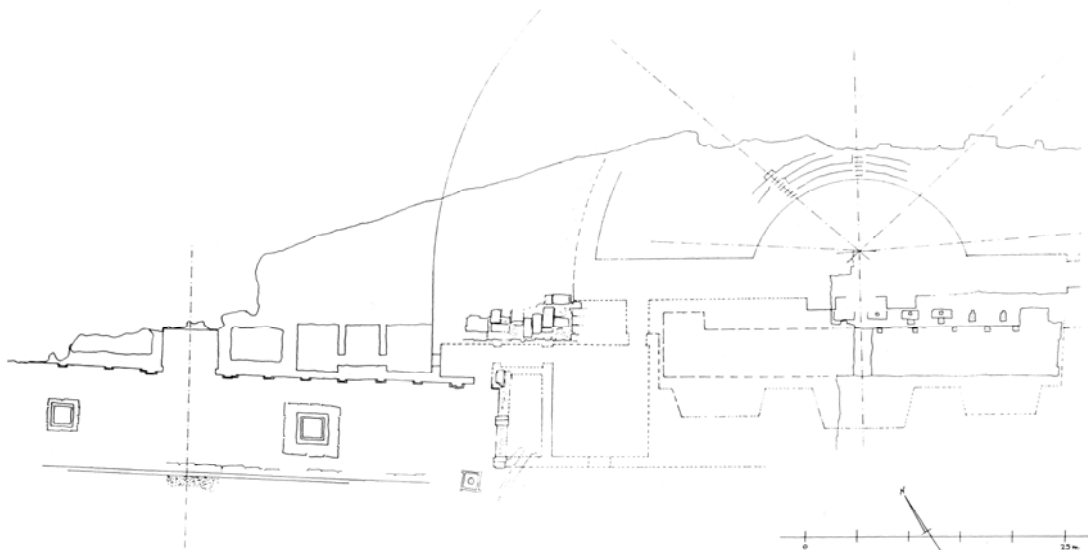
Planta del teatre de Tàrraco amb els elements localitzats de la seva fundació. (MAR 1992)
